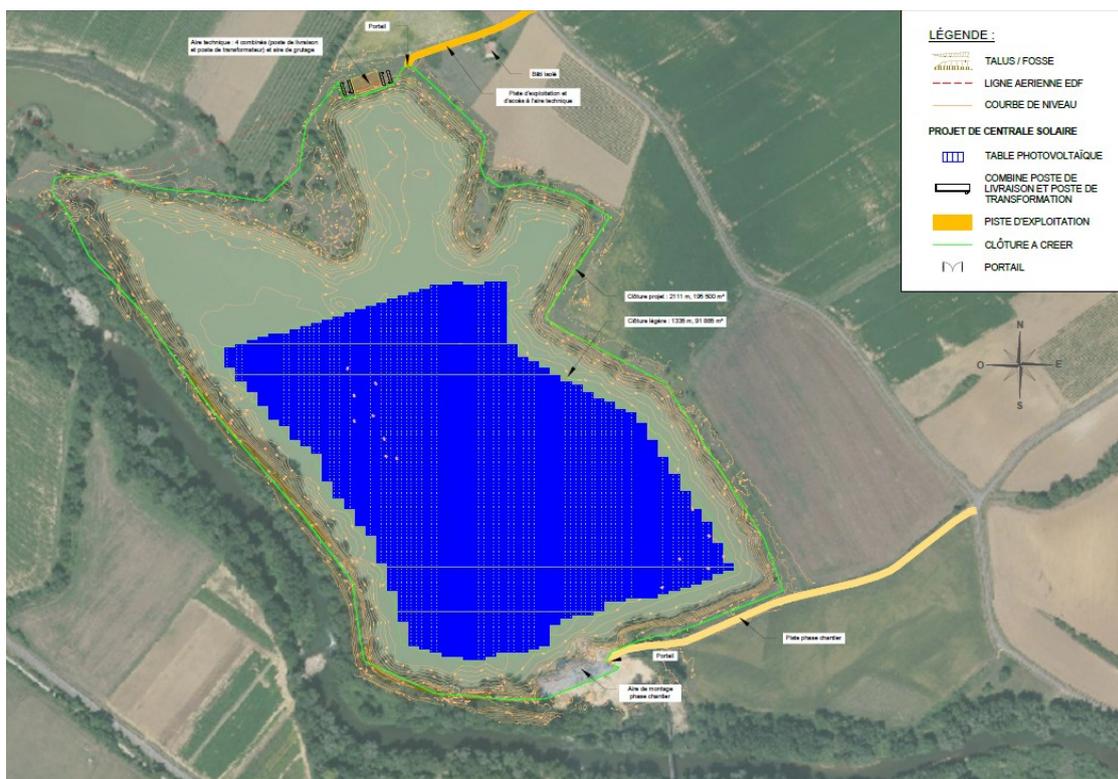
plan de masse du projet – orthophoto IGN- extrait des plans du PC
